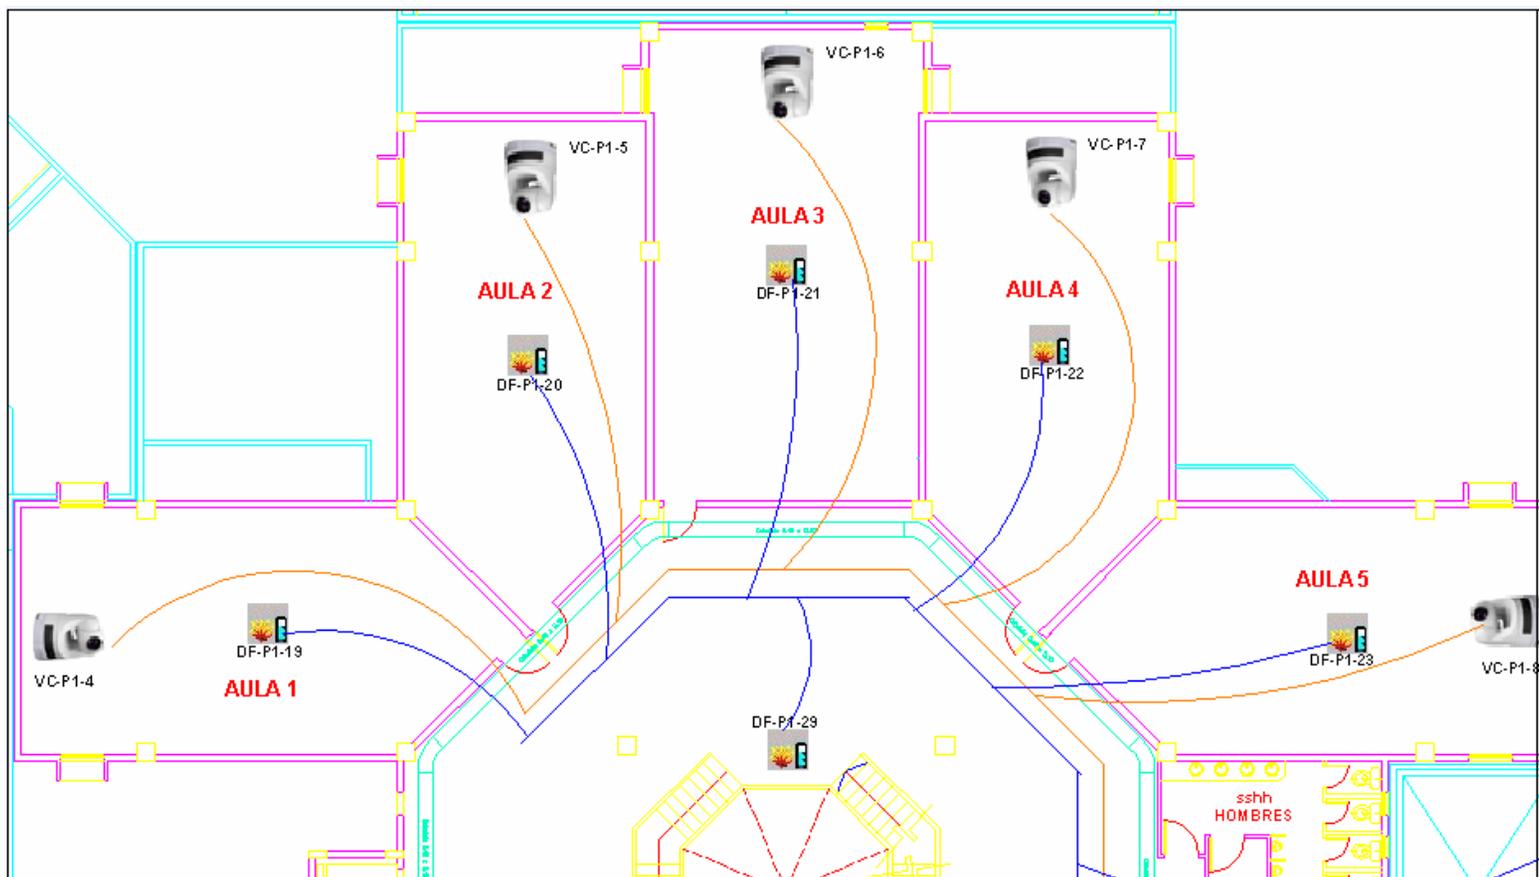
PLANO SEGURIDAD PRIMER PISO SECCION 1
